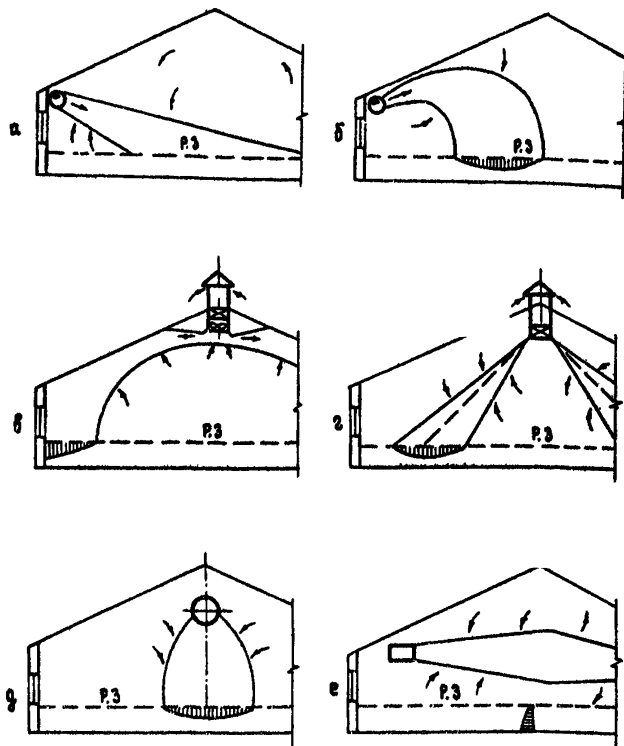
Рис. I. Основные схемы организации воздухообмена в животноводческих помещениях приточными вентиляционными струями:
